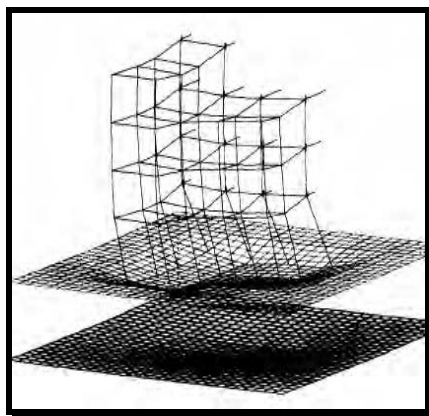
ã Pórtico Espacial (Estrutura-Solo)
